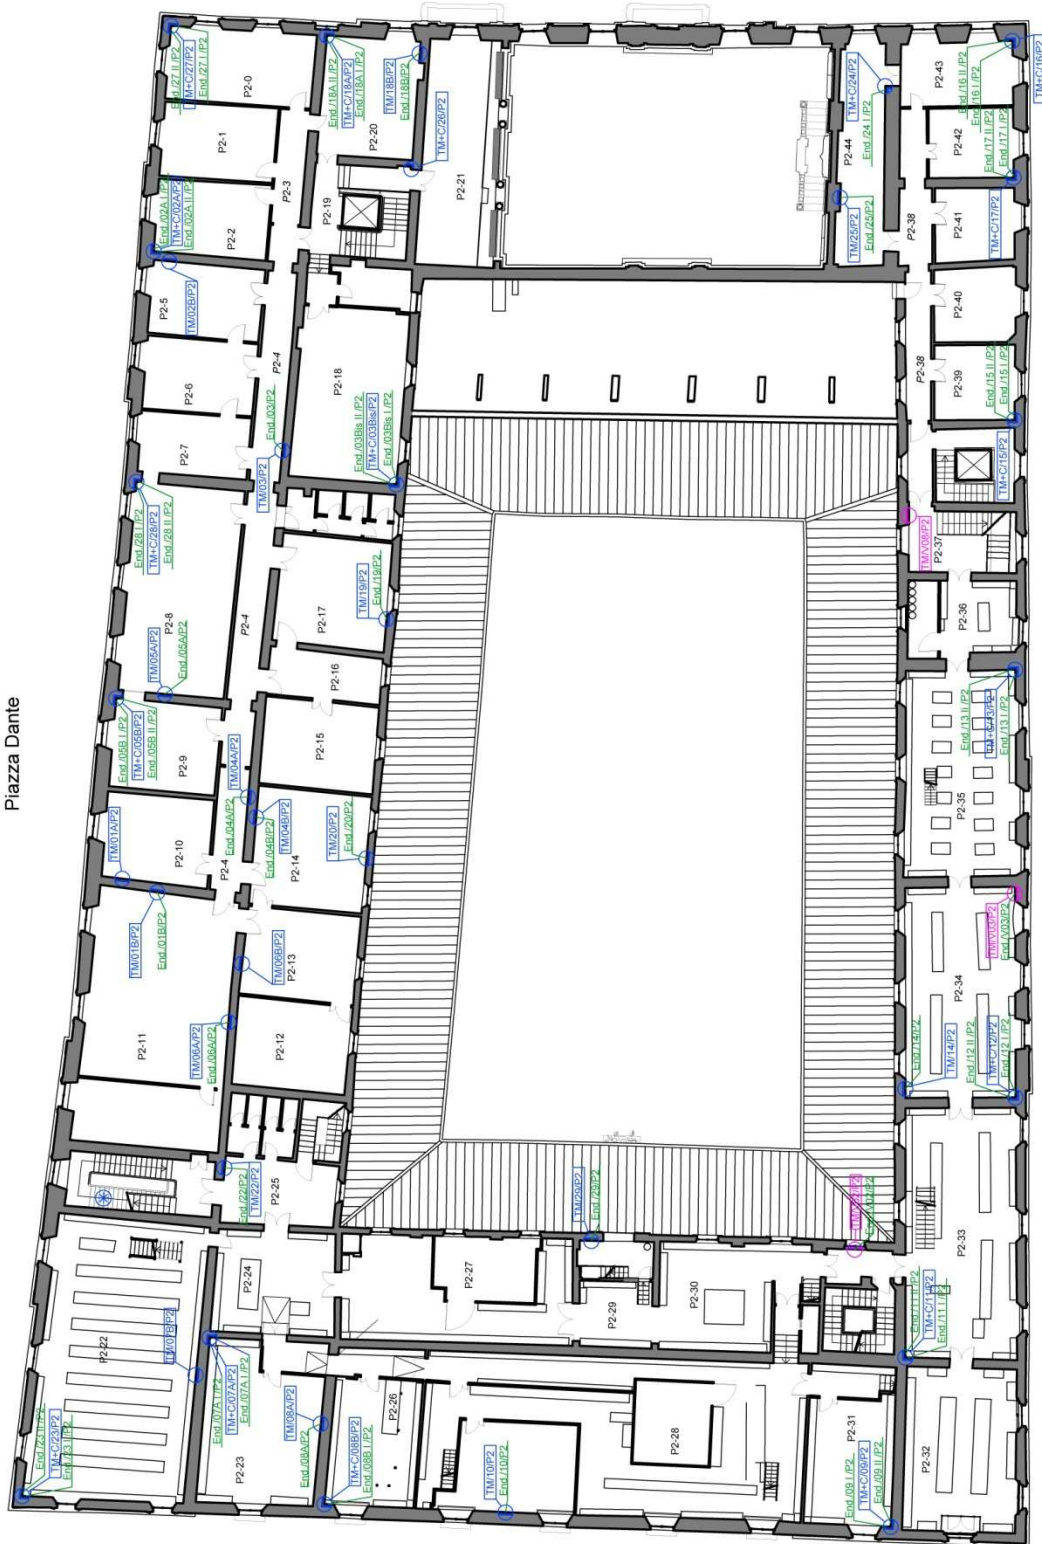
Pianta piano primo. Schema della posizione dei saggi e delle endoscopie
